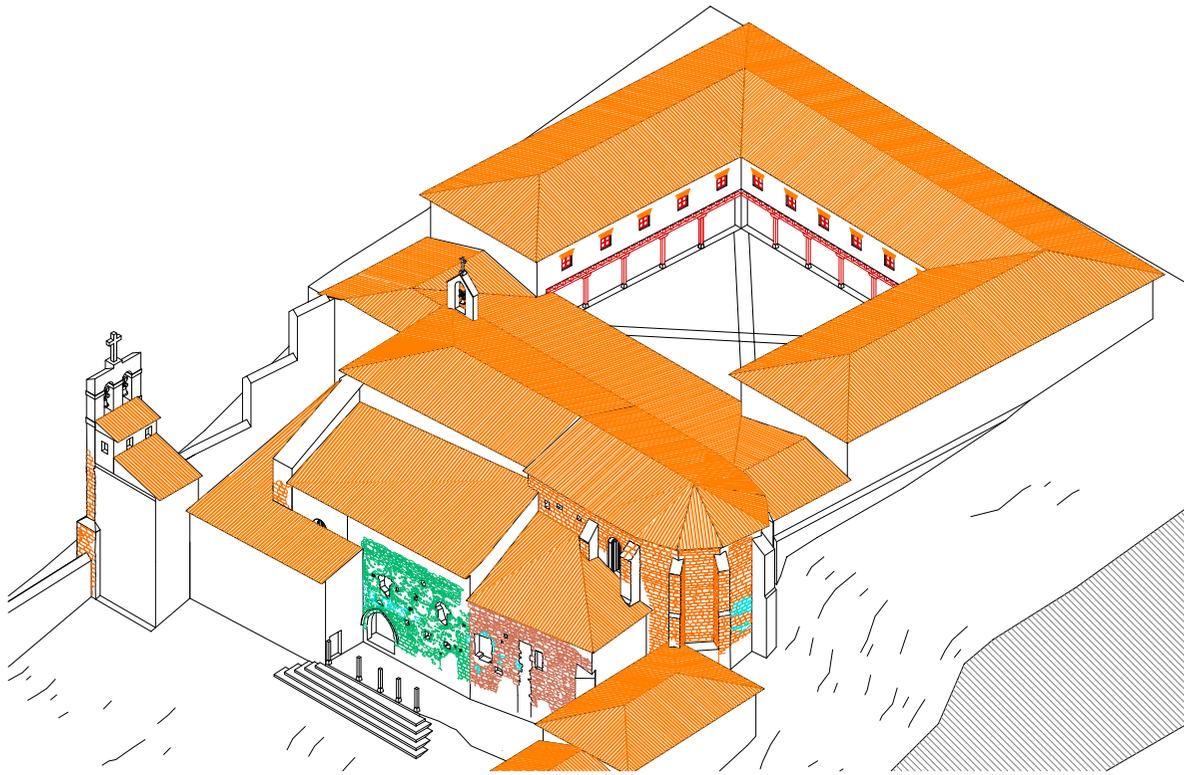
Vista en detalle de la reconstrucción del convento vista desde el sureste.
